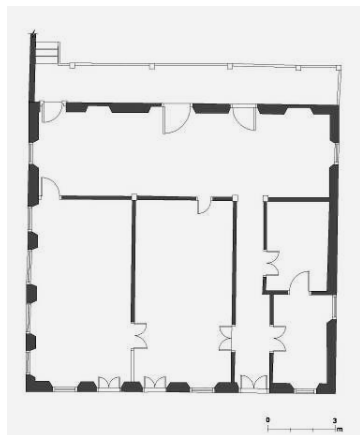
Planta Casa individual Sra. Leila Marques da Rocha
